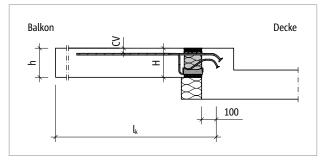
Schöck Isokorb® XT Typ K-U: Statisches System
